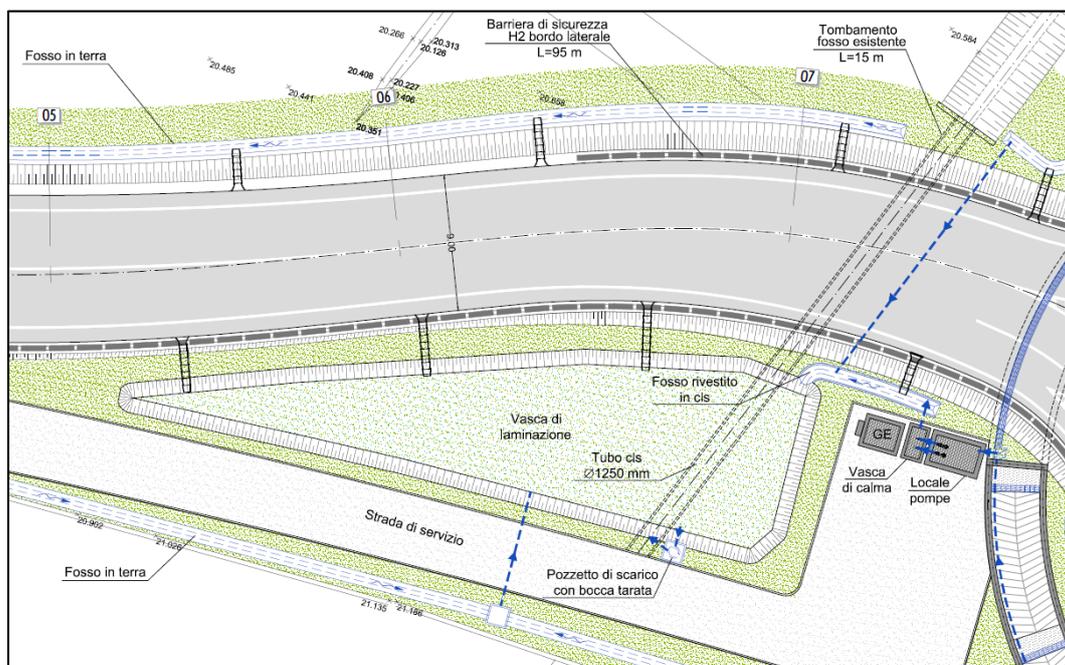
Dettaglio della vasca di laminazione e del relativo sistema fognario (elaborato di progetto “OI.01 Planimetria opere idrauliche”).
